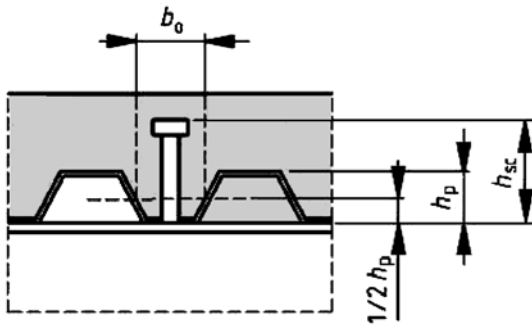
Балка з профільованим сталевим настилом поперек балки
